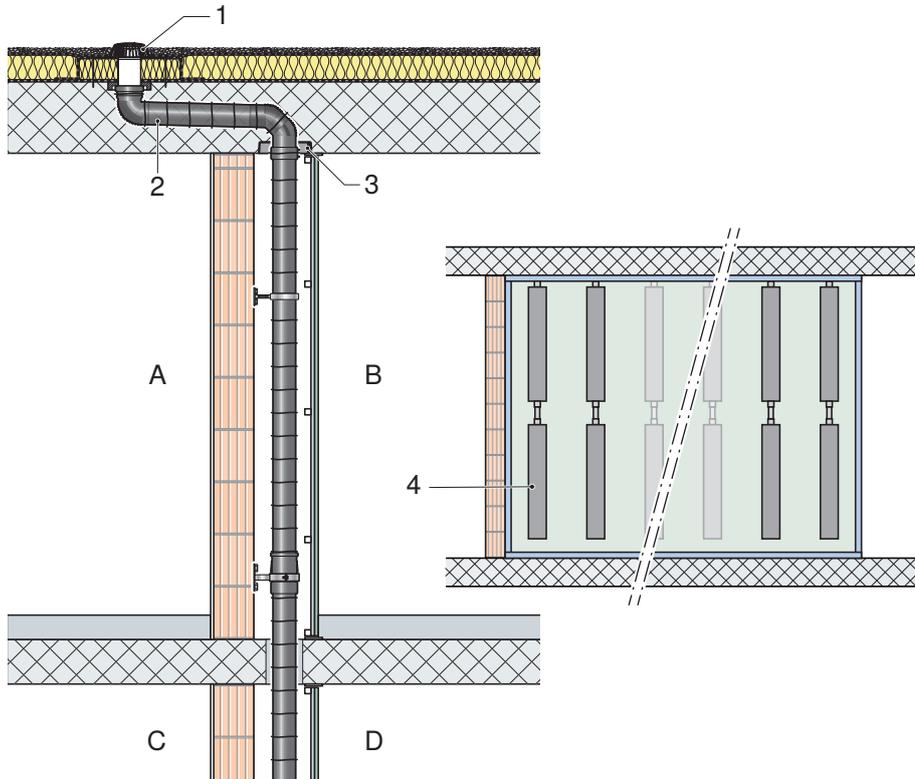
Ansicht Dachwasser-Falleitung mit eingelegter Anschlussleitung
